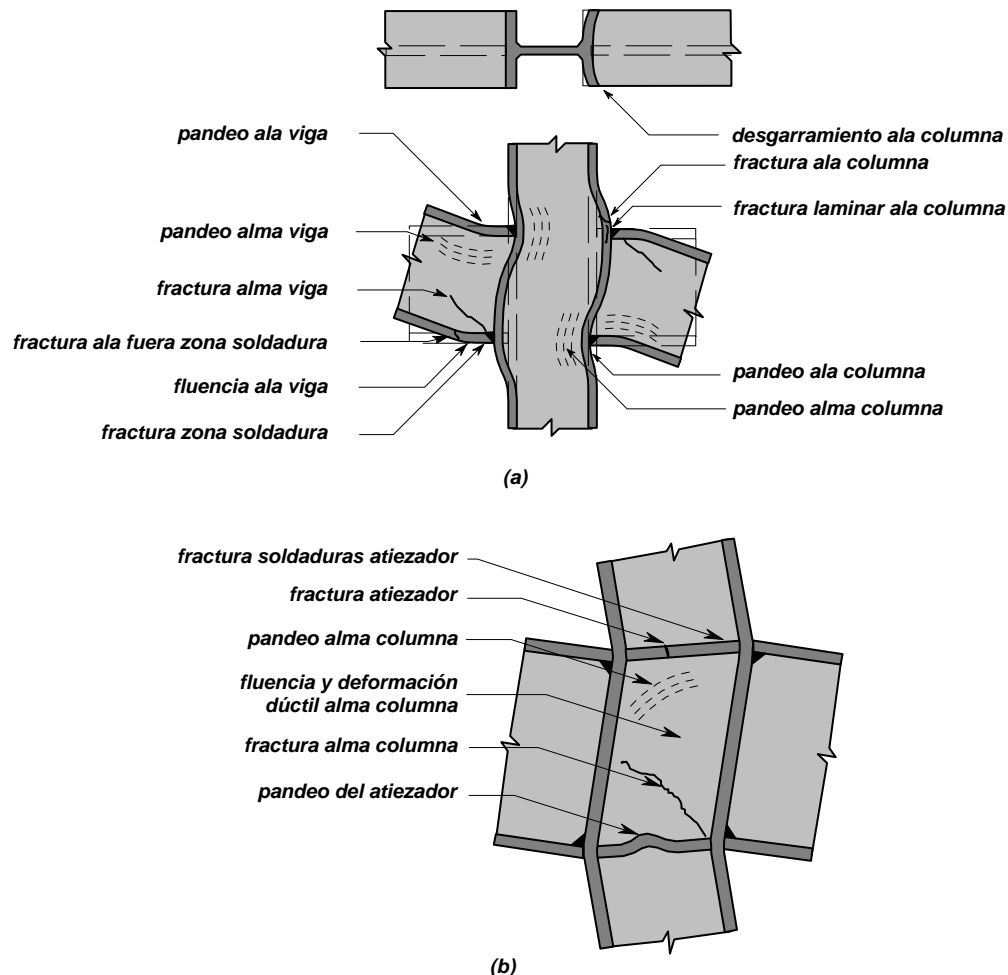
Tipo de problemas en la zona del nudo en estructuras de acero
